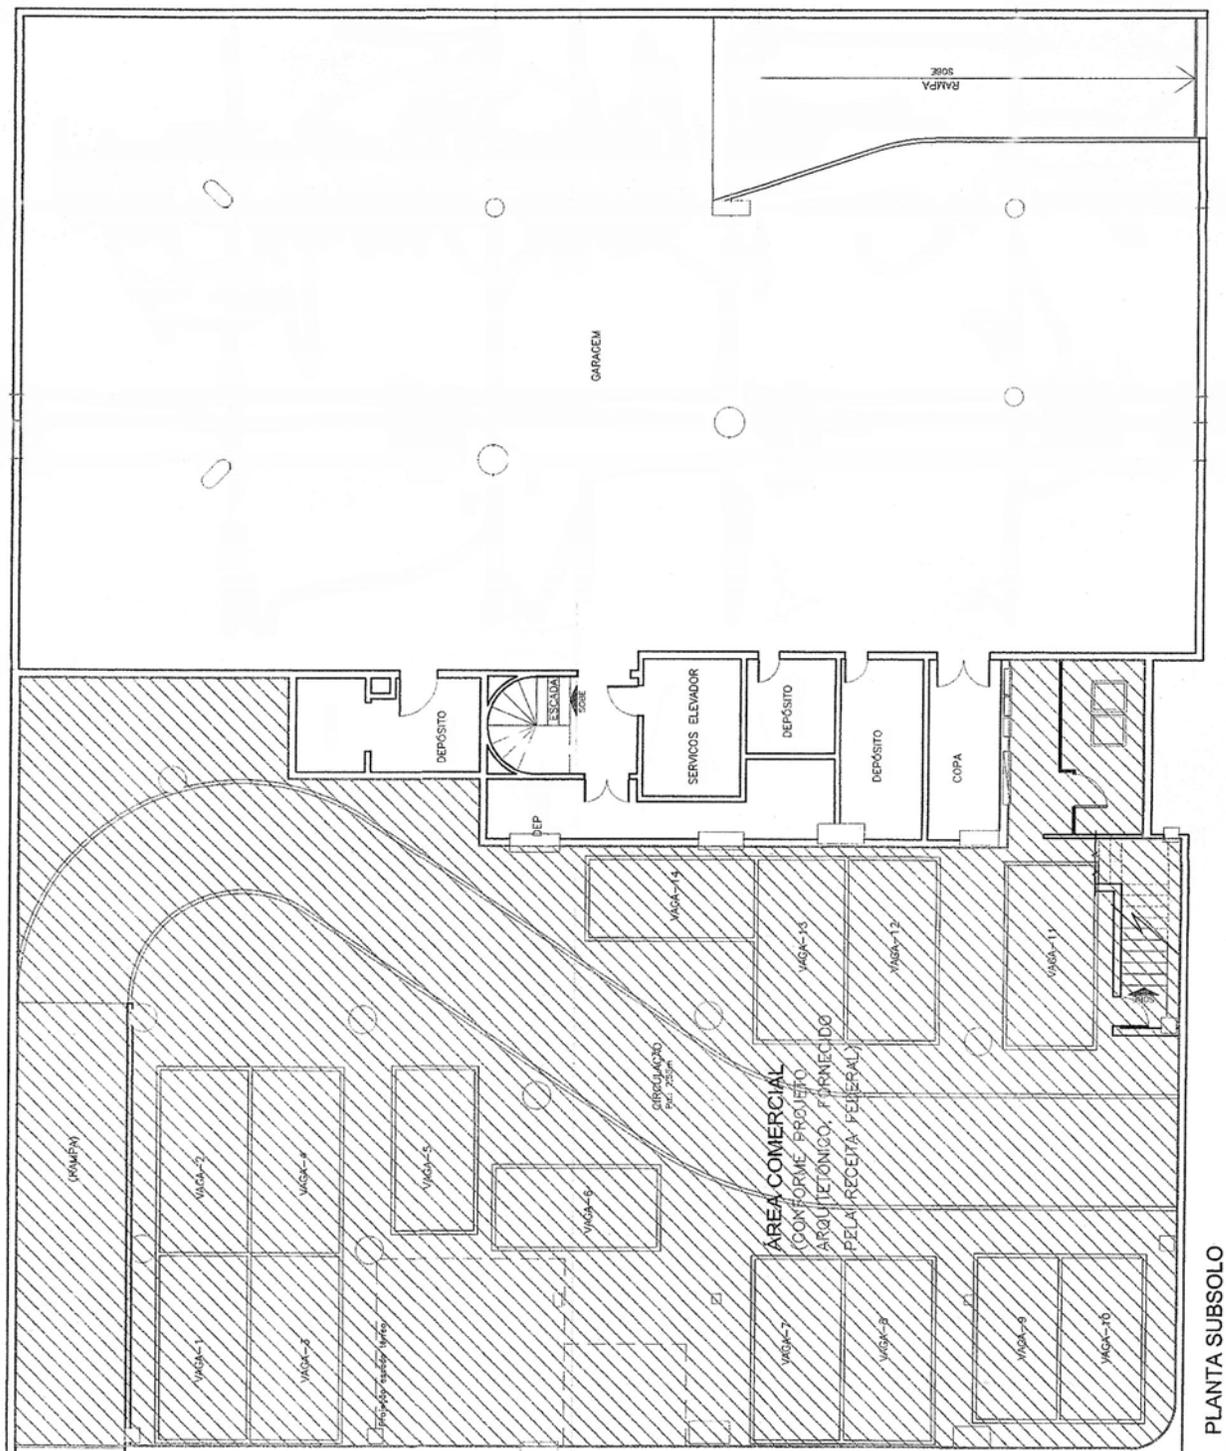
Planta baixa do subsolo (sem escala) do edifício EC 3
